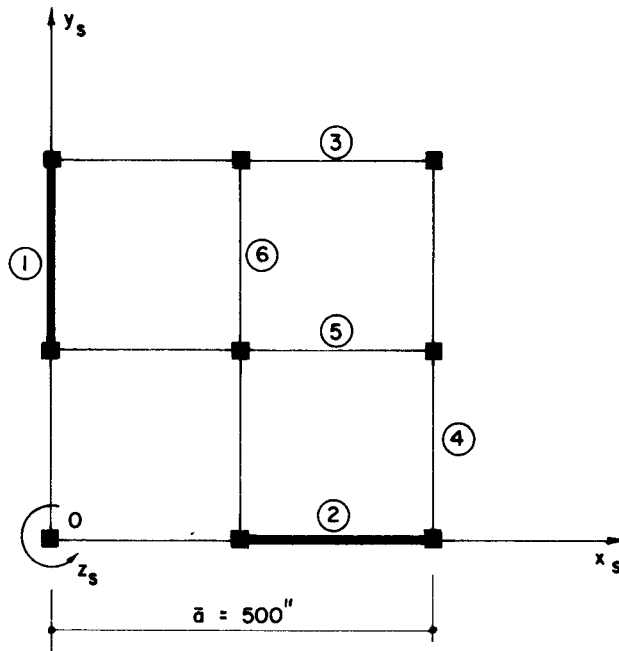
20 - Planta do edifício do exemplo 5 .
